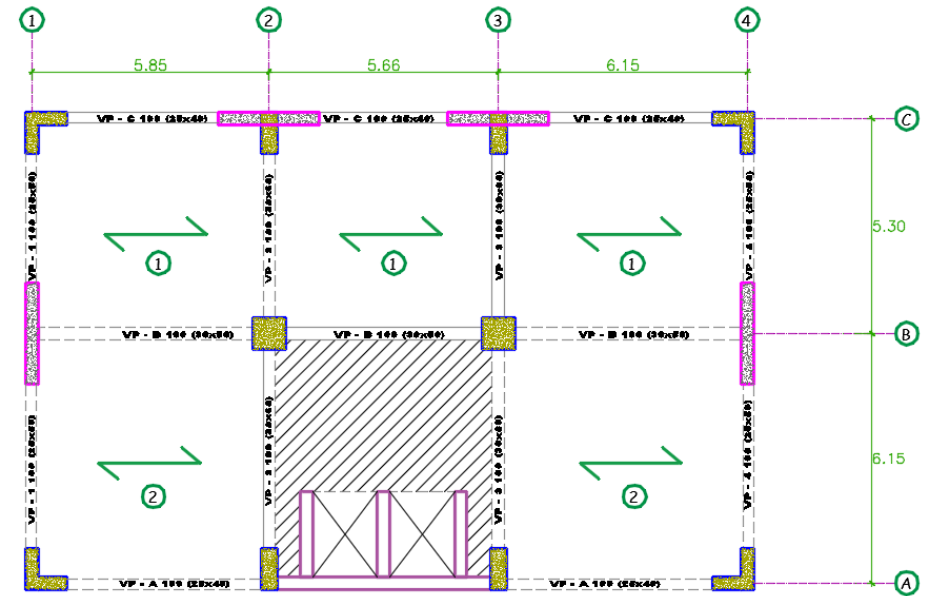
Plano estructural del 2º al 12º piso de la alternativa 02
